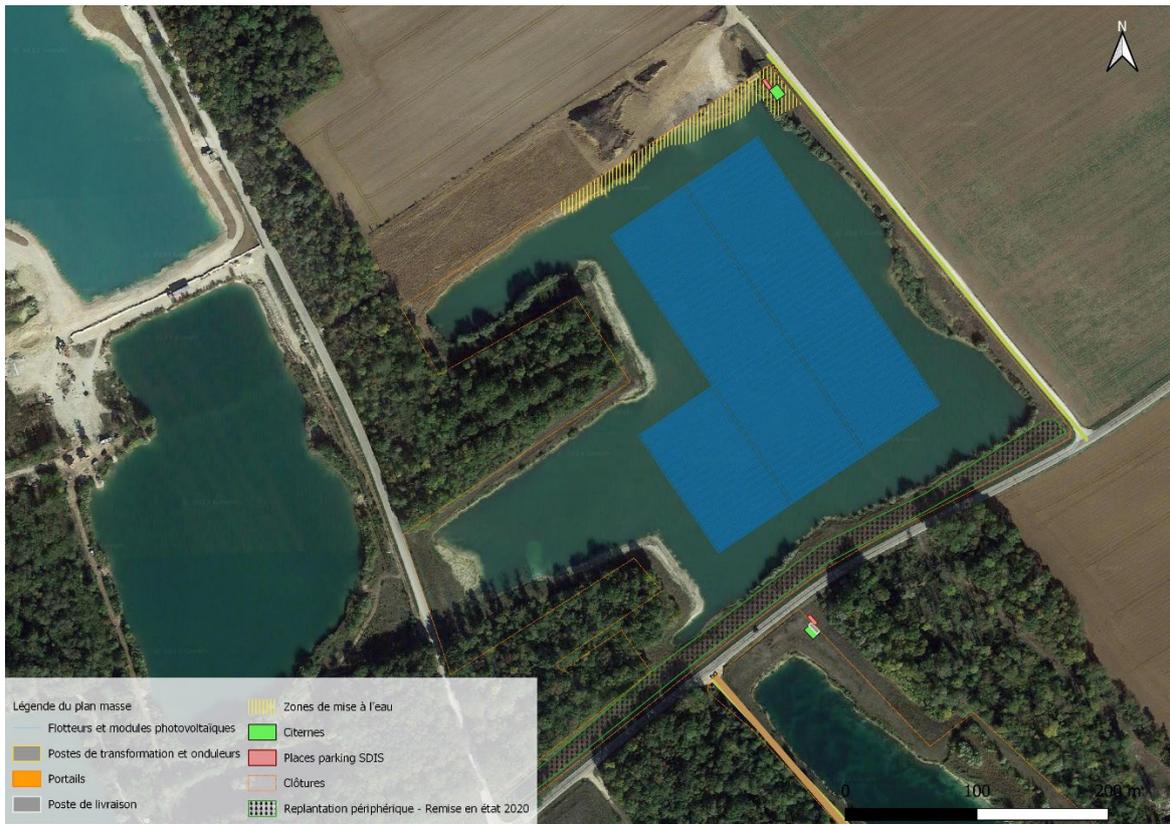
Plan masse du plan d'eau Nord pour le projet de centrale photovoltaïque flottante et Replantation périphérique de remise en état de la carrière en 2020
